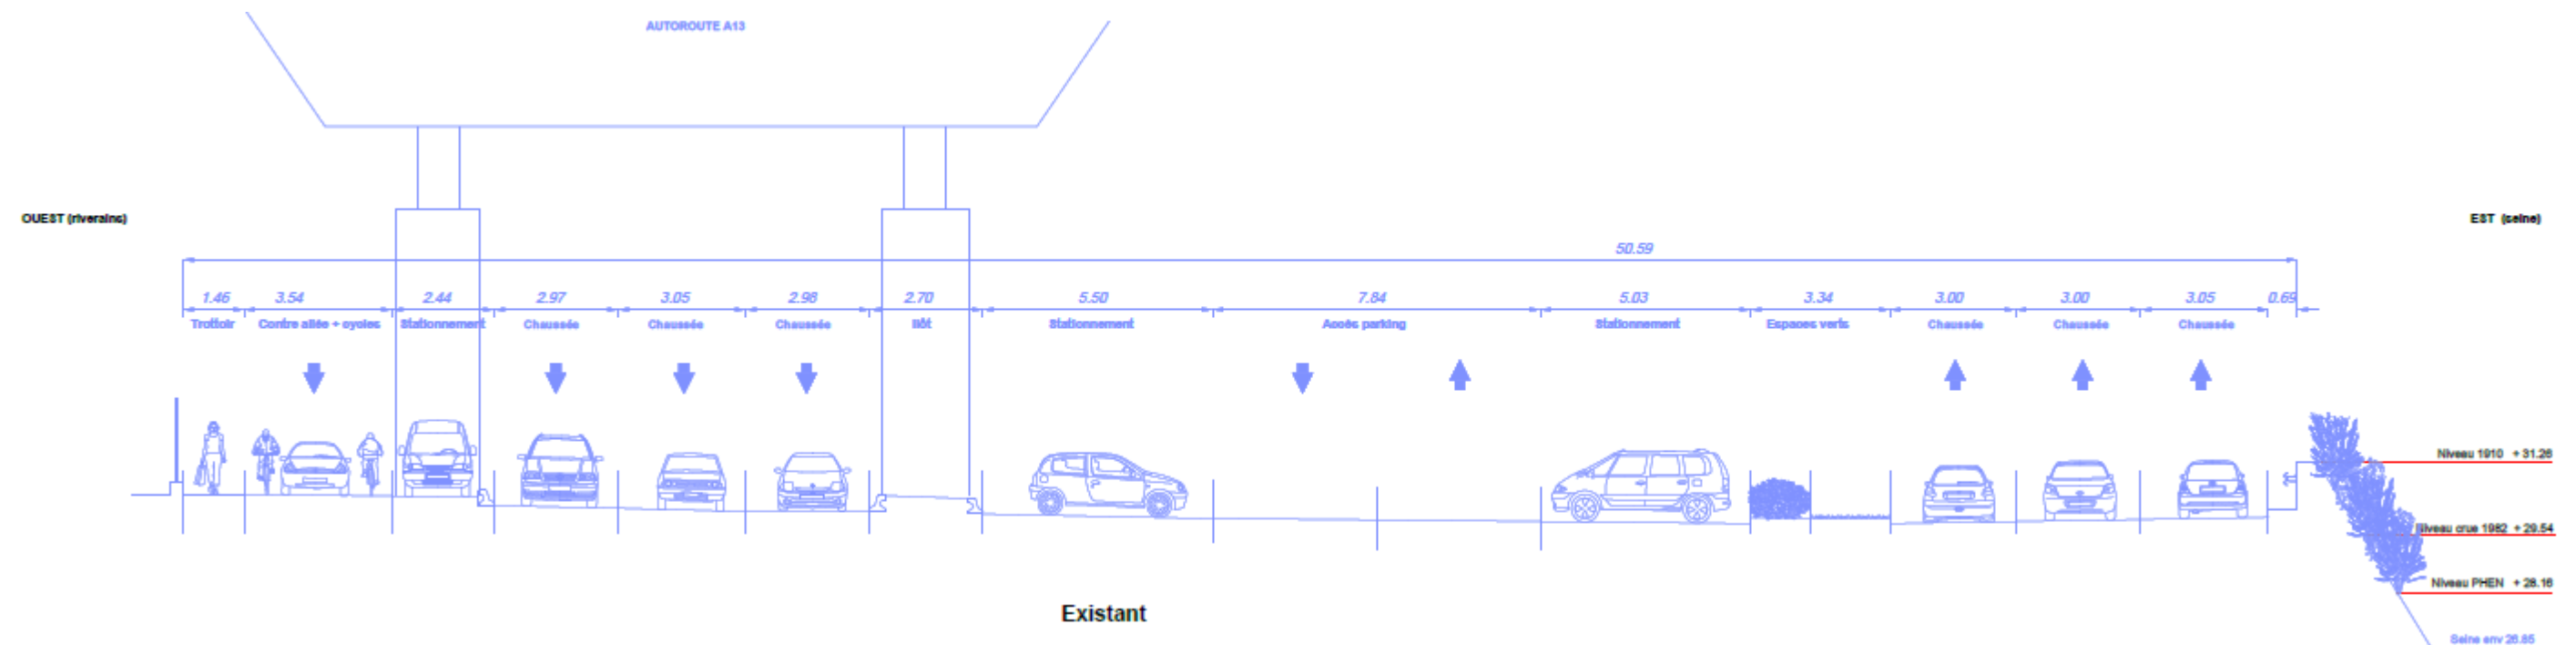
profil-type de l'existant entre la rue du 18 juin 1940 et la place Clemenceau
